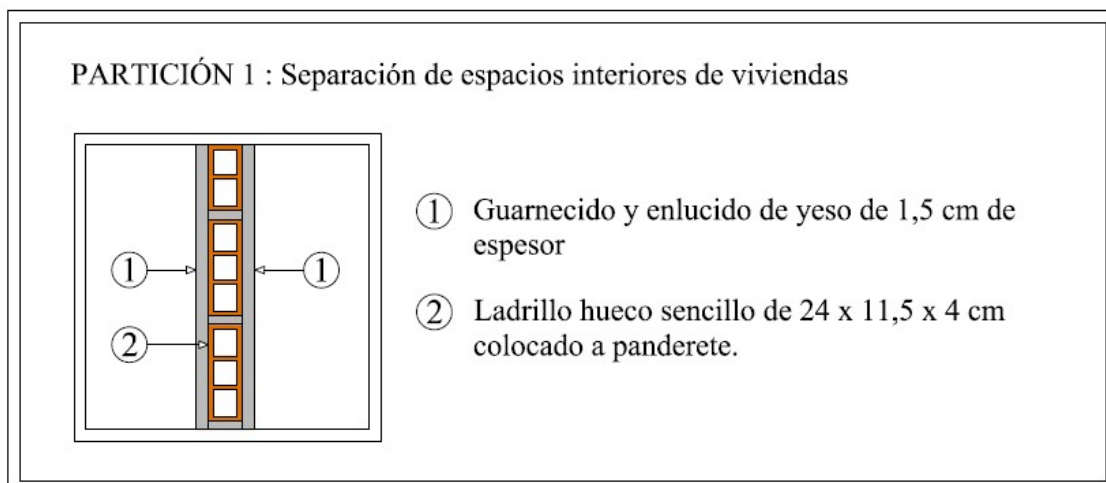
Detalle constructivo 4; Fuente: Autor)
